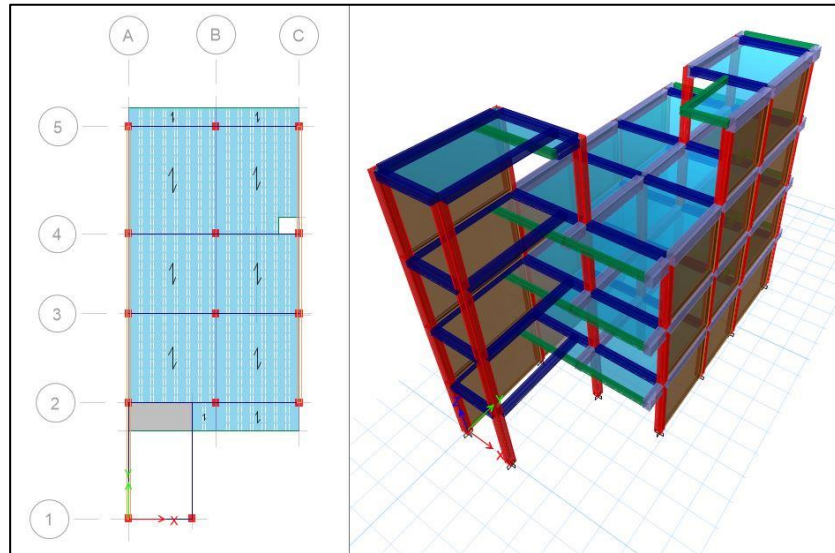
Vivienda Informal de 3 Pisos (HU-3), Vista en Planta (Izquierda) y Vista 3D (Derecha)
